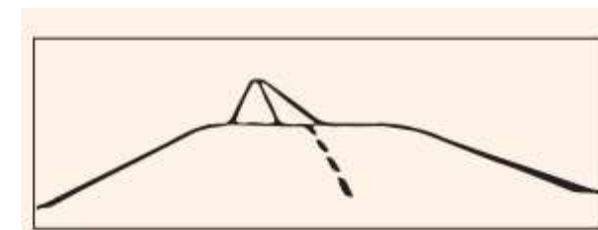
Situaciones a evitar en la coordinación planta alzado (V)
